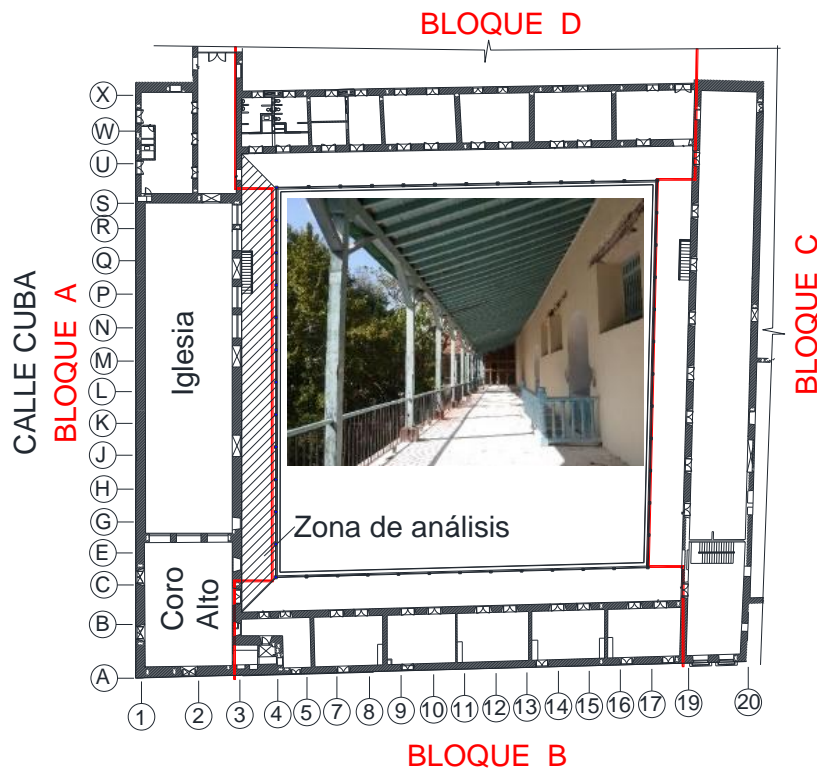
Esboço da planta do primeiro claustro, placas e fotografia da galeria estudada
